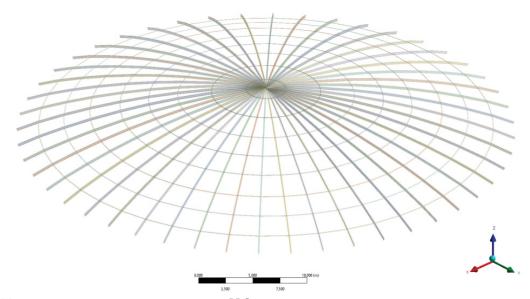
Моделирование несущего каркаса крыши PBC Fig. 3. Modeling of the supporting frame of the tank roof
